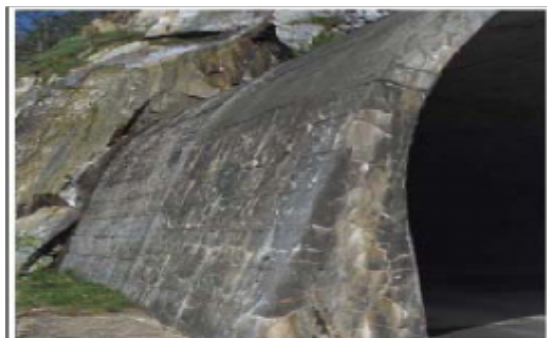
Entrée d'un tunnel. Fissurations grossières dues
